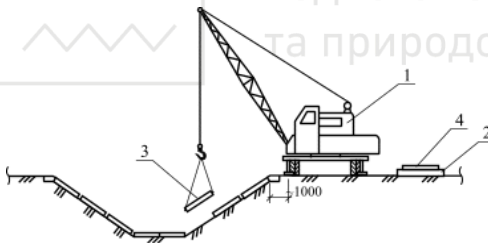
Схема заміни плит НПК. 1 – автокран КС-3575А; 2 – дерев'яна підкладка; 3 – демонтована плита; 4 – нова плита НПК
